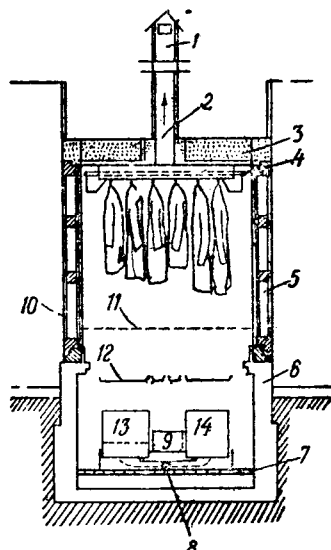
Продольный вертикальный разрез камеры Розанова:
